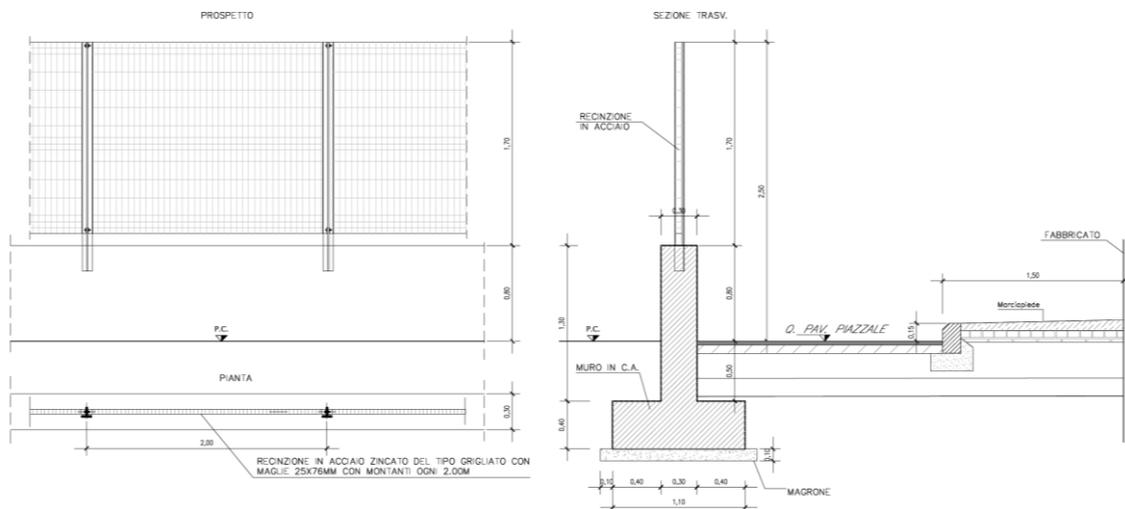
PT03 Particolare muro di recinzione, pavimentazione piazzale e marciapiede
